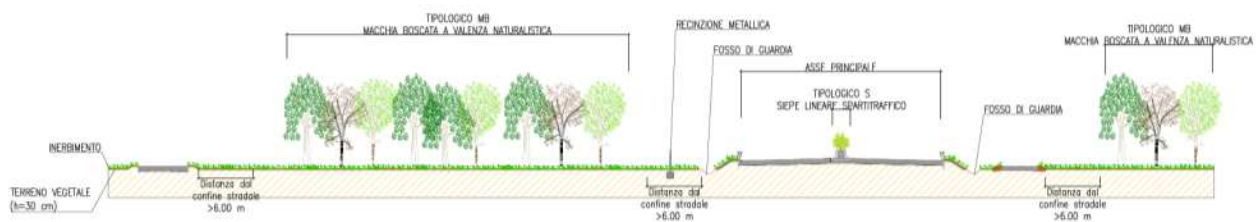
Sezione in corrispondenza del Cavalcavia con evidenza delle opere a verde con tipologia di impianto Mb
